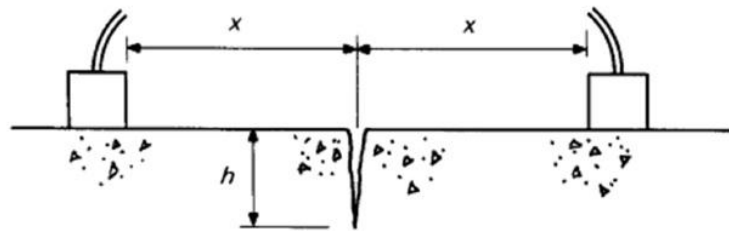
Esquema para a determinação da profundidade de fissura.
